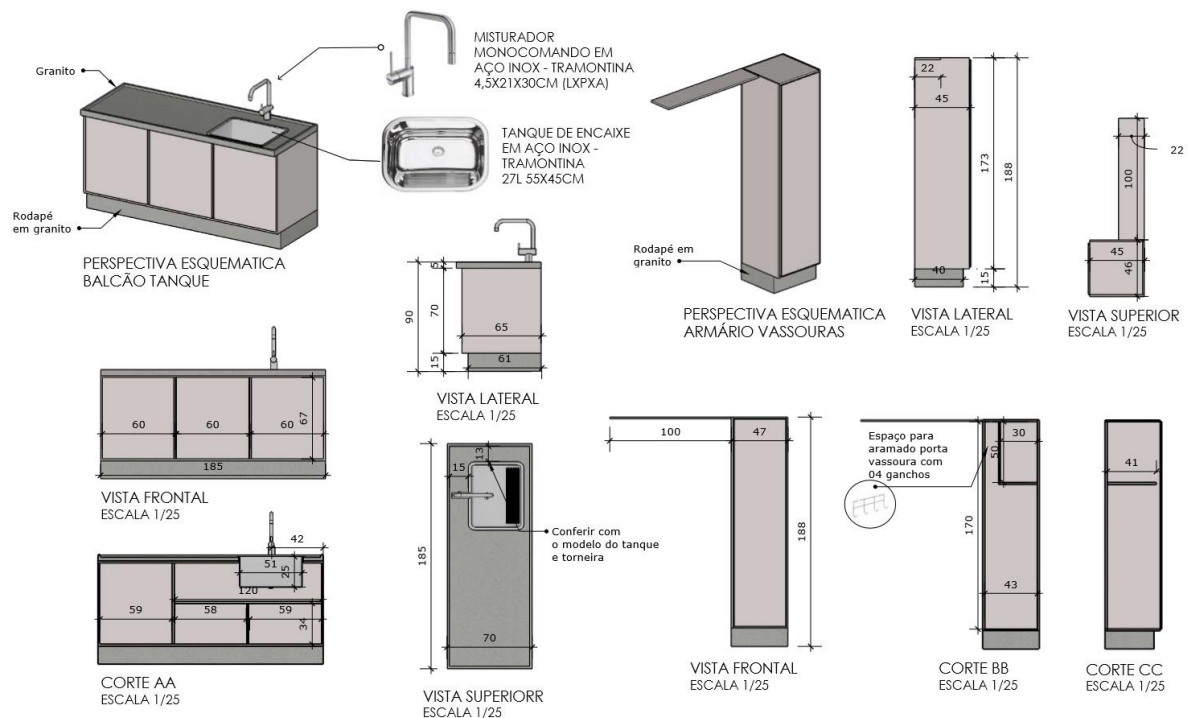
Detalhamento técnico lavanderia, elevações e planta baixa.
